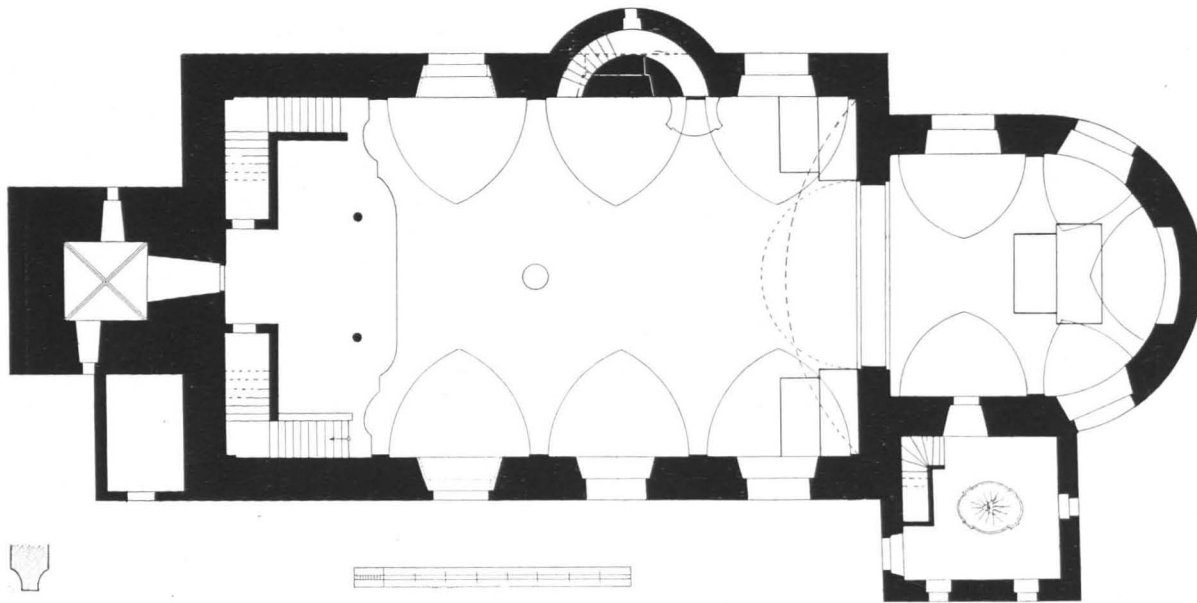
St. Georgen, Pfarrkirche, Grundriß 1 : 250 (S. 444)
